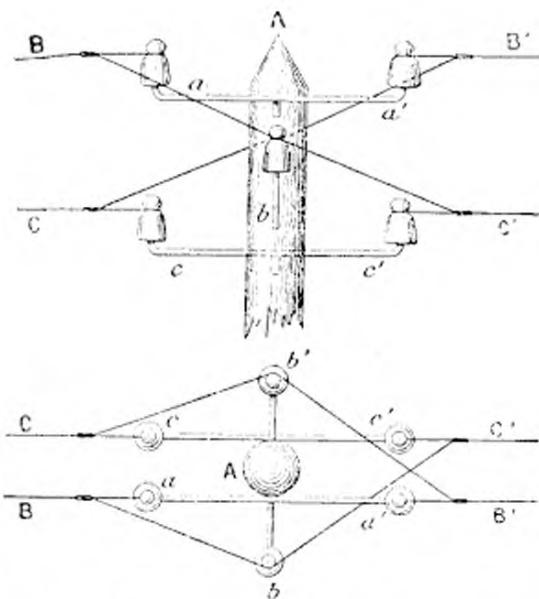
et 417. -- Gisement des fils sur les poteaux.
